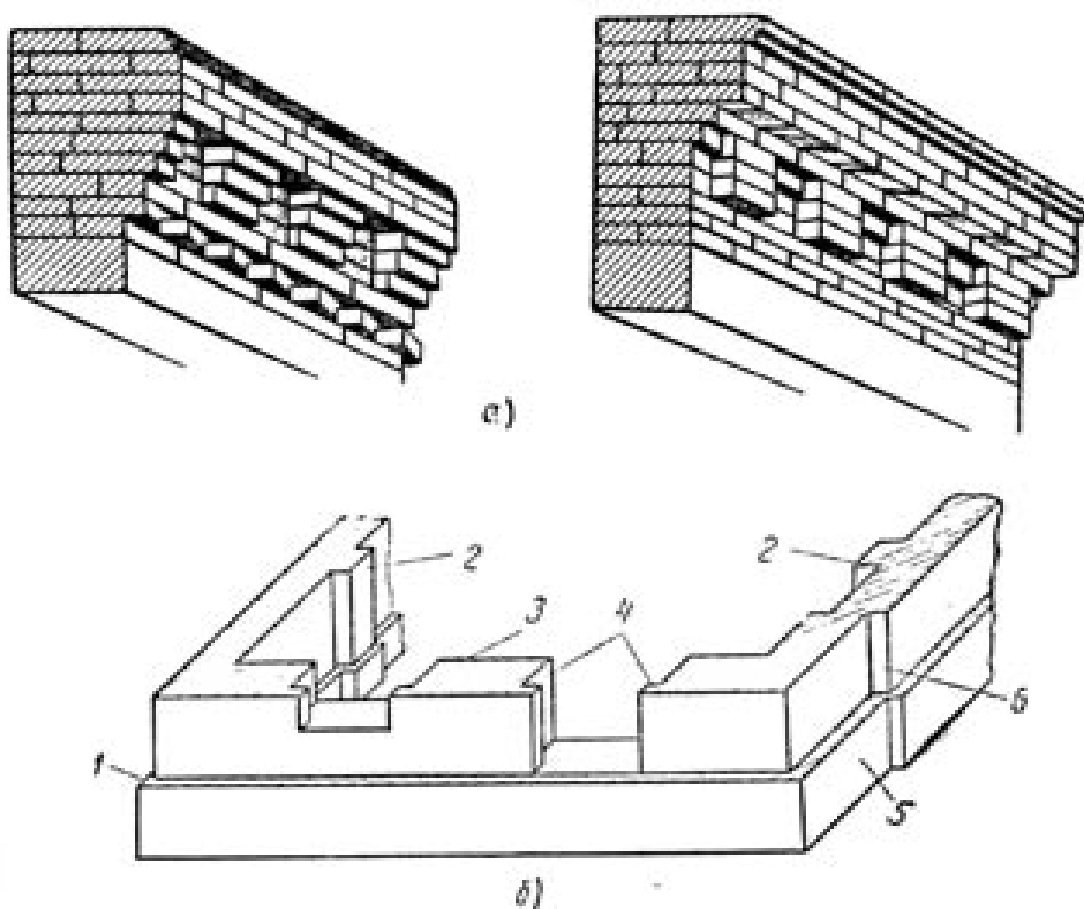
Кладка карнизов с напуском кирпичей (а) и элементы стены кладки (б):
